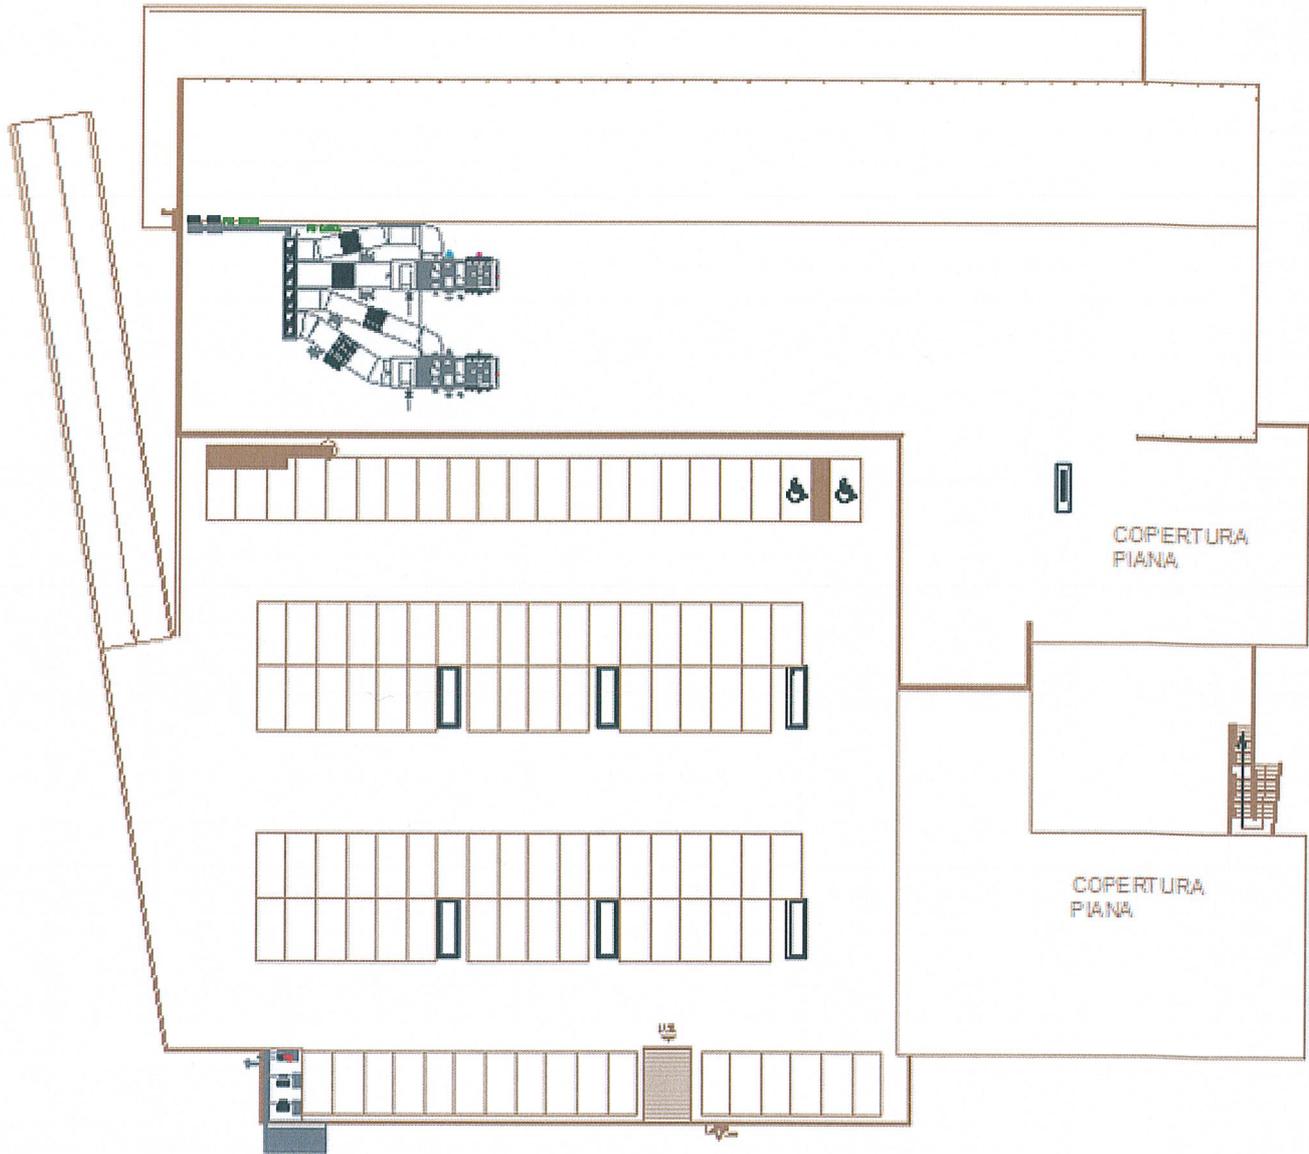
Planimetria dell'attività da progetto – piano copertura
